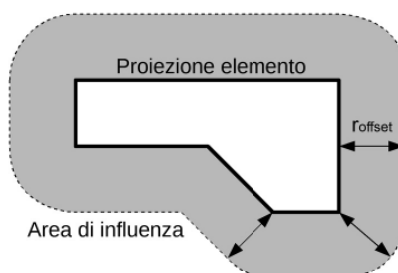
Costruzione dell'area di influenza di un elemento, in pianta
